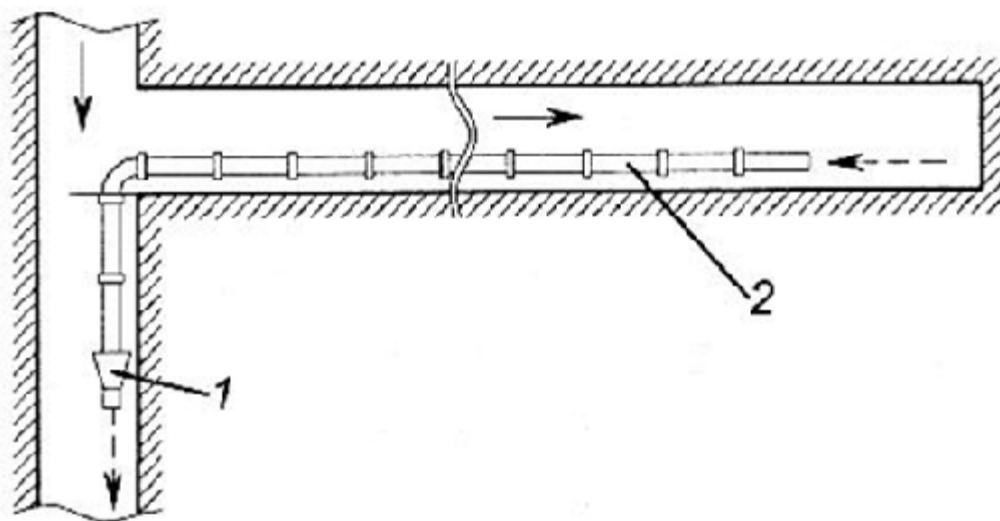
Схема всасывающего проветривания тупиковой выработки: 1 – всасывающий вентилятор; 2 – всасывающий трубопровод.
